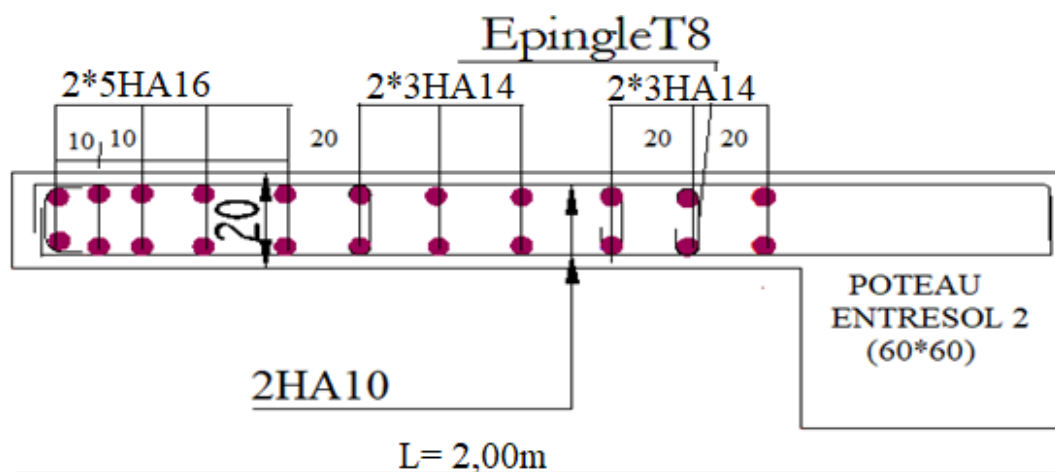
Schéma de ferrailage du voile VY4 au niveau d'entresol 2
